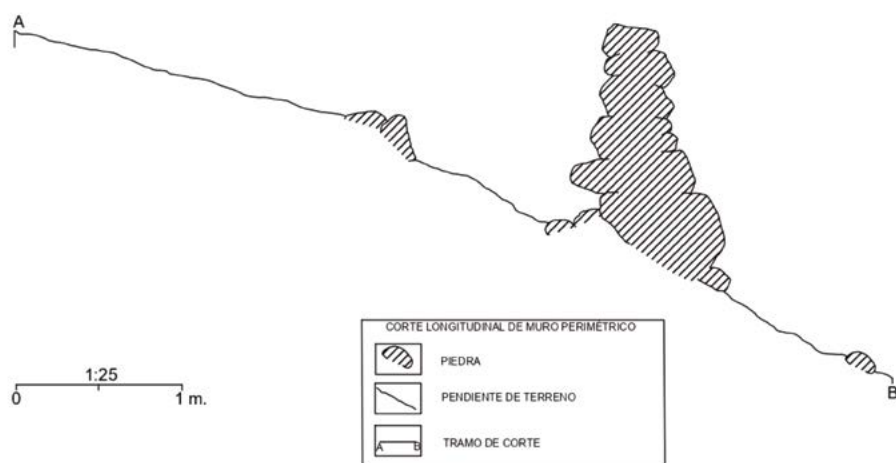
Muro perimetral en la zona oeste del asentamiento.
